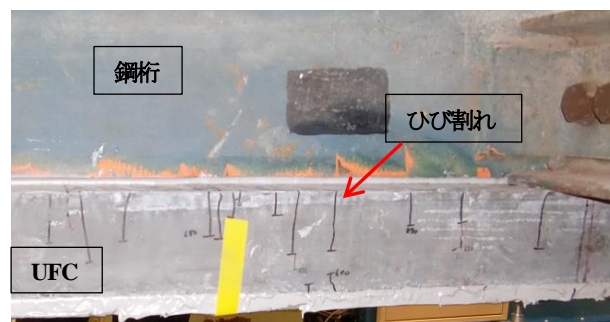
実験後 UFC 補強部のひび割れ発生状況例
